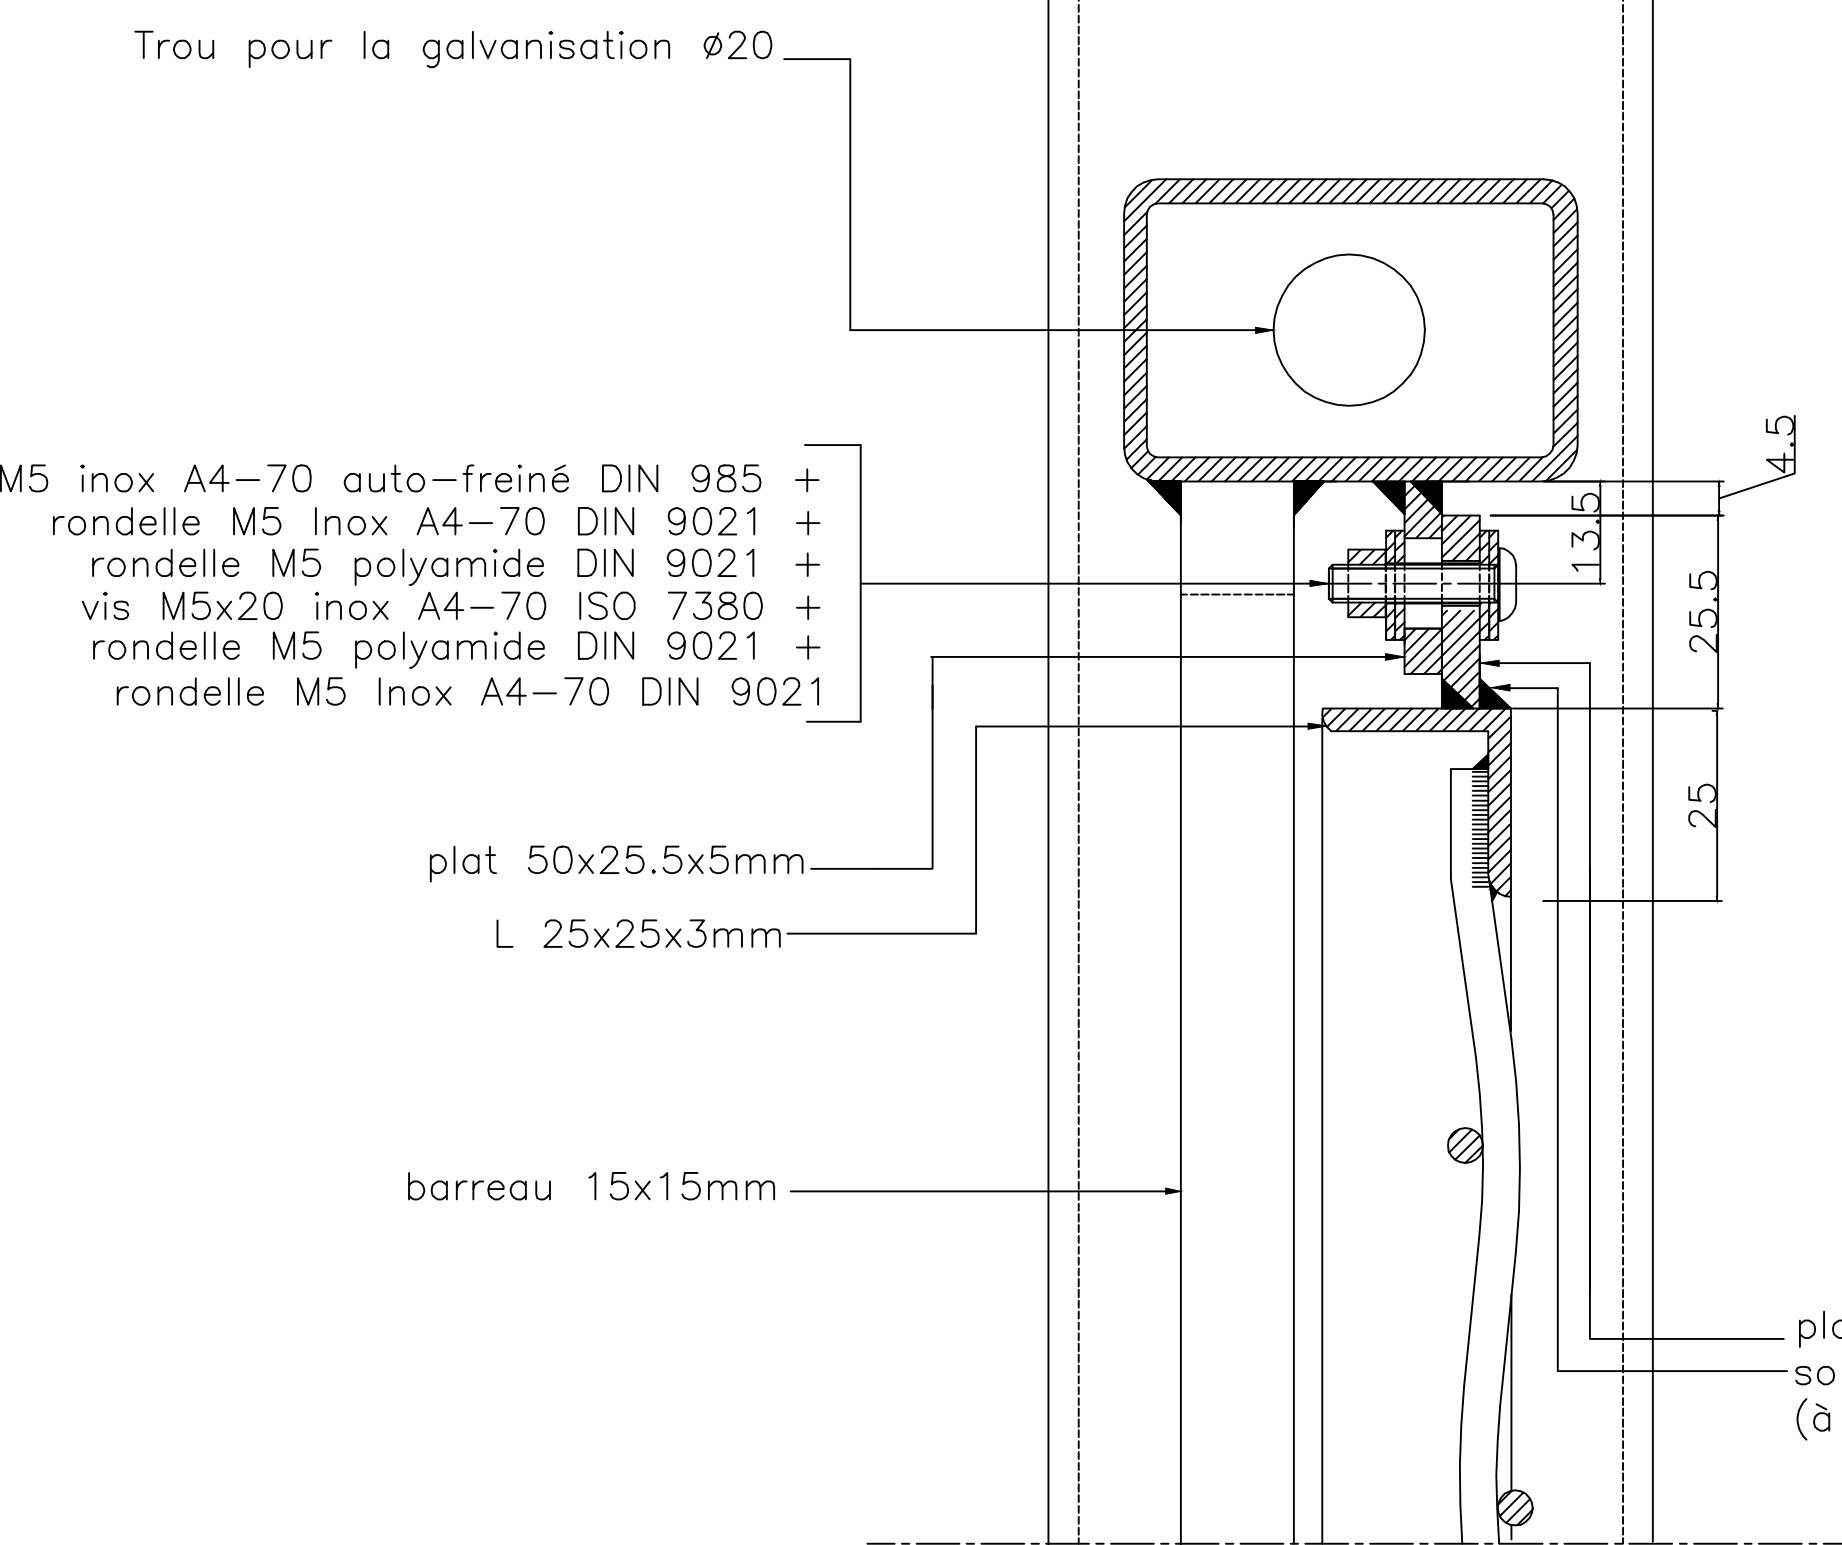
DETAIL JOINT DE POSE (tous les 7m50 maximum) Ech: 1/2
